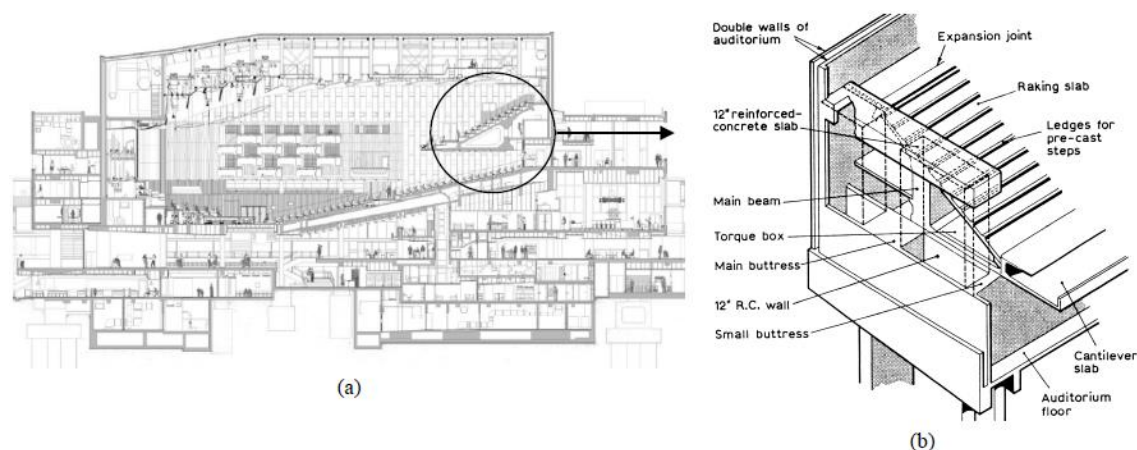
Royal Festival Hall*, Londres. (a) Corte transversal do edifício. (b) Corte da viga triangular em caixão para apoiar a laje em consola. [75].
